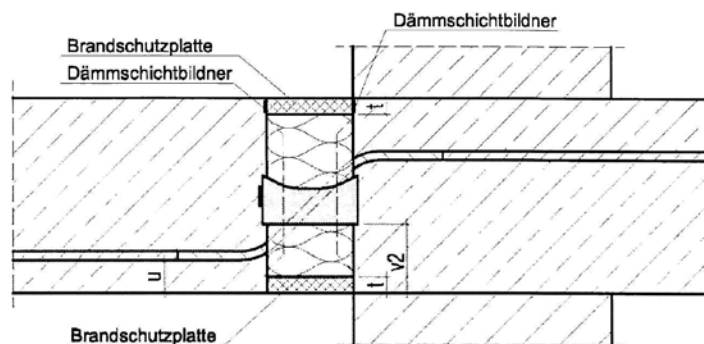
Schöck Isokorb Typ Q (Ausführungsvariante A) gem. Abschnitt 2.1.3, Var. b)
